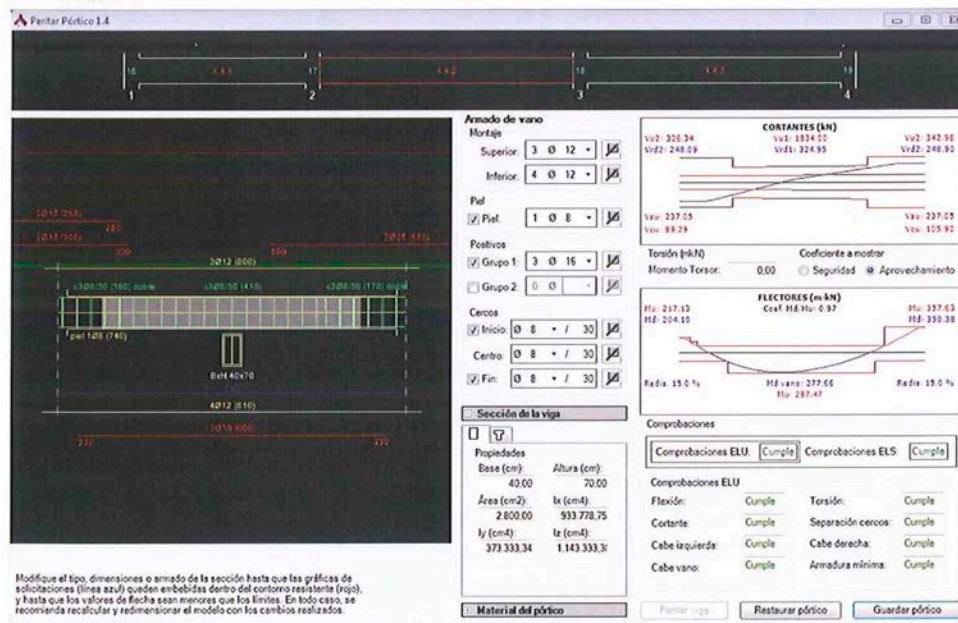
Cálculo de la armadura de la viga con el programa Architrave
